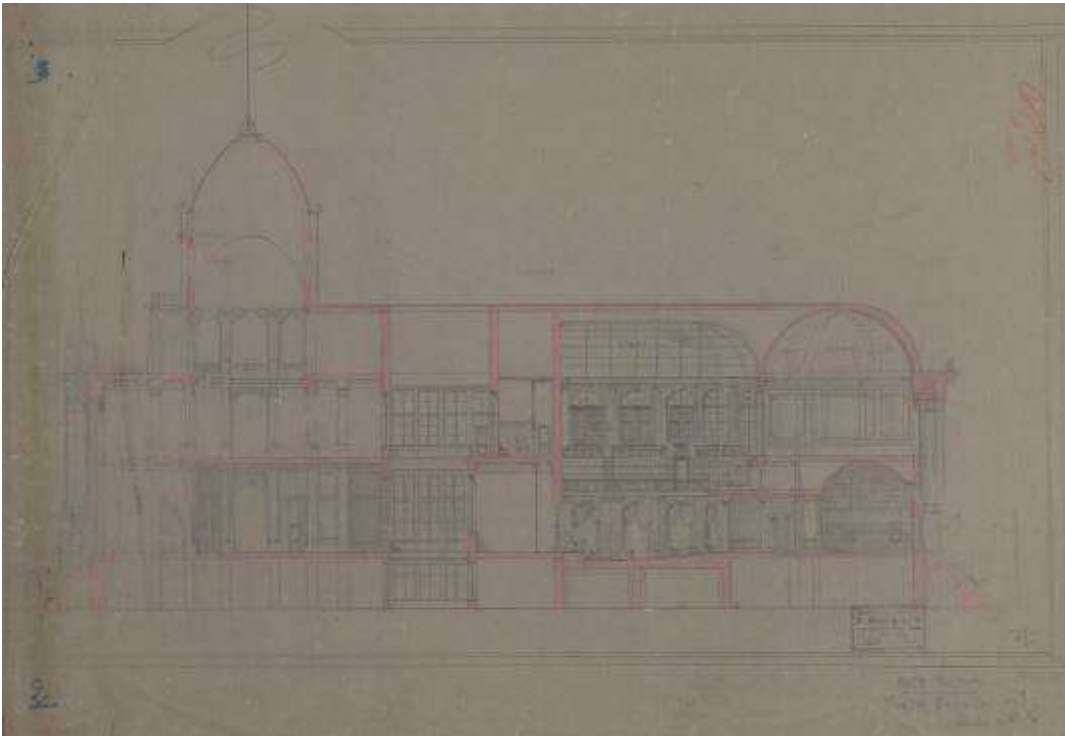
Corte Transversal, proposta de construção de um anexo para abrigar a plenária (Fonte: Arquivo Nacional).
